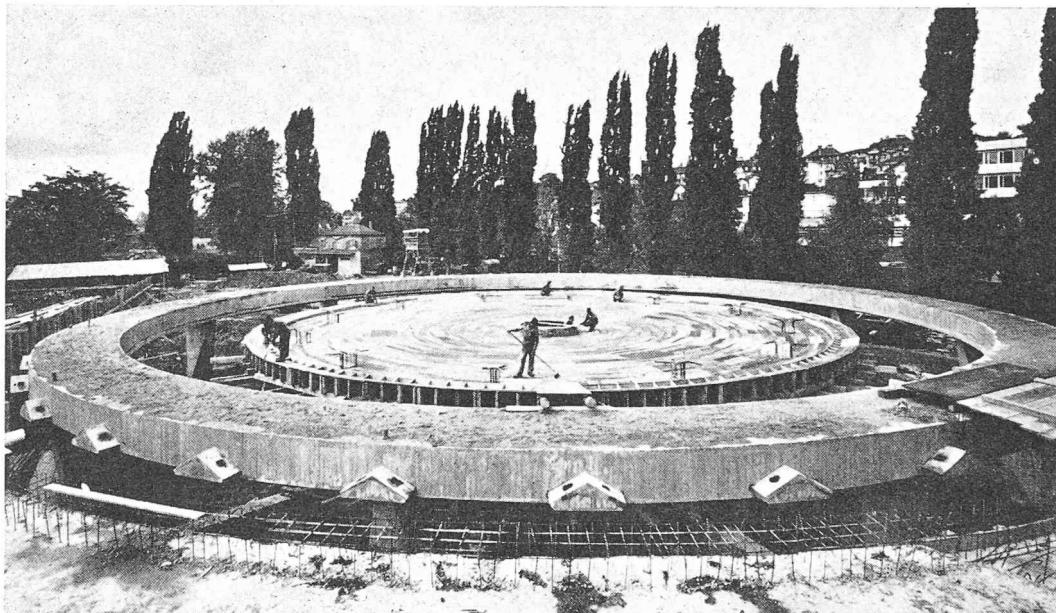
La dalle circulaire et l'anneau en chantier.
